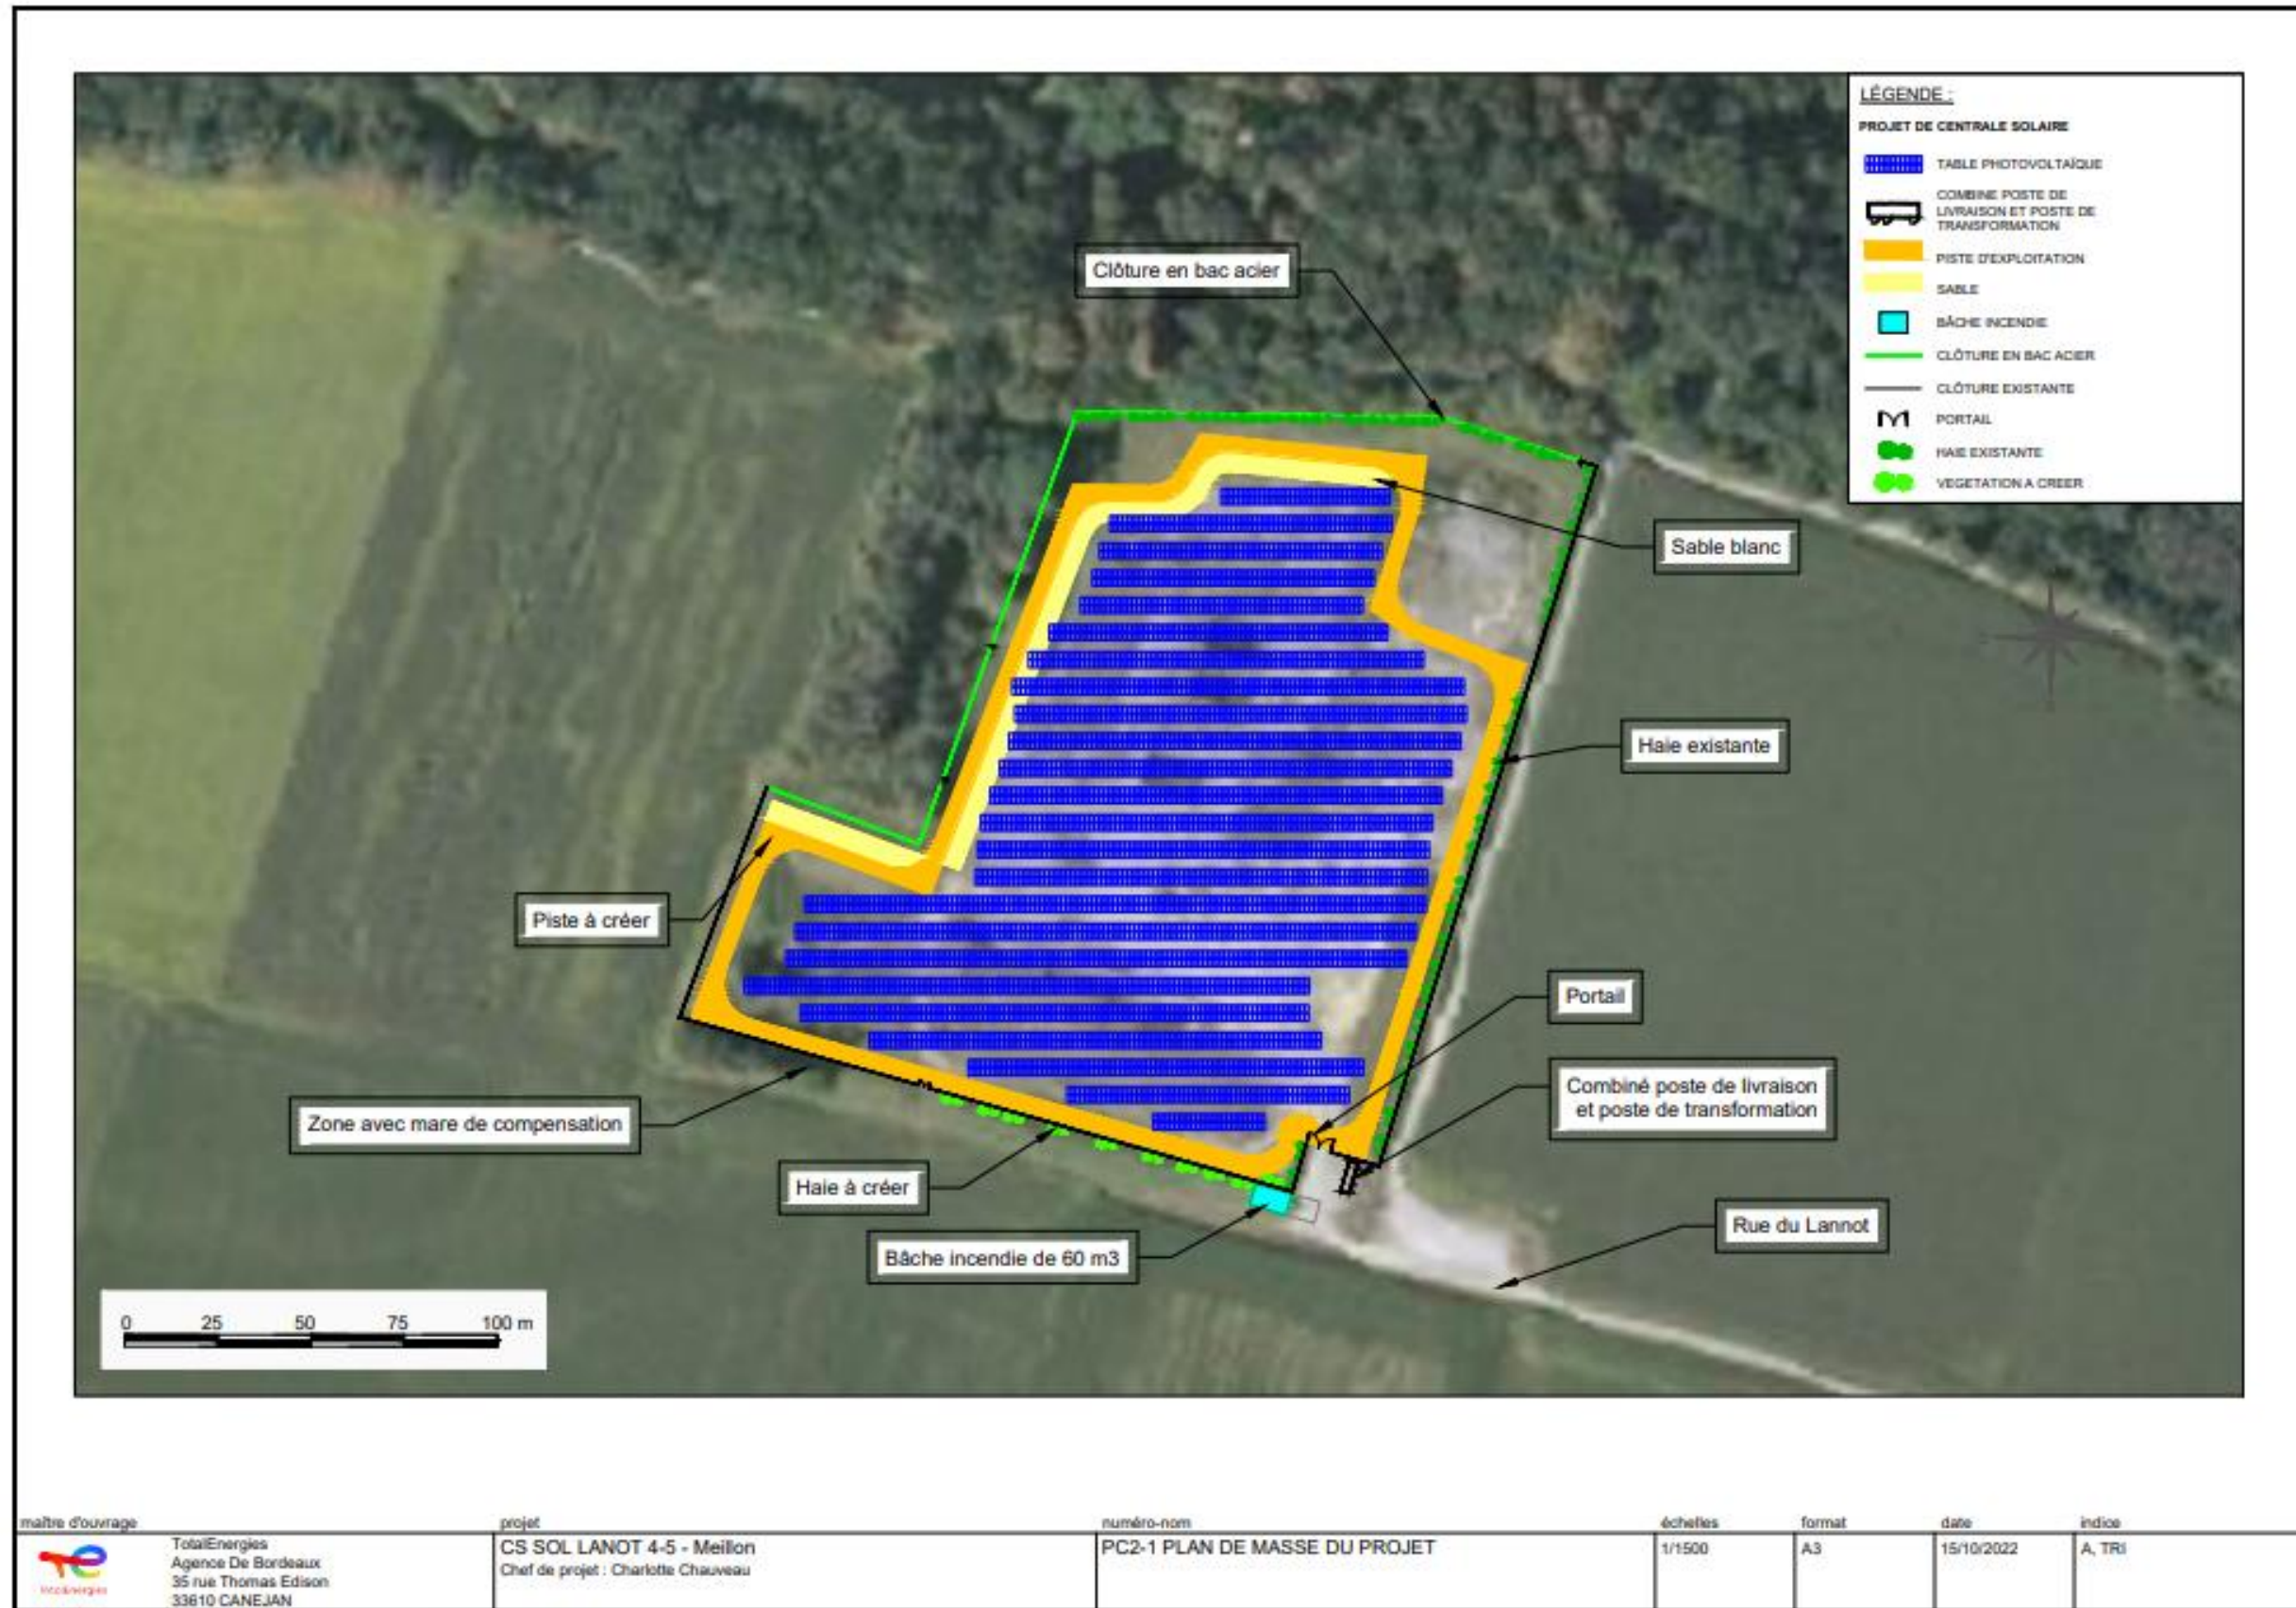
Plan de masse du site Lanot 4-5 (Meillon)
